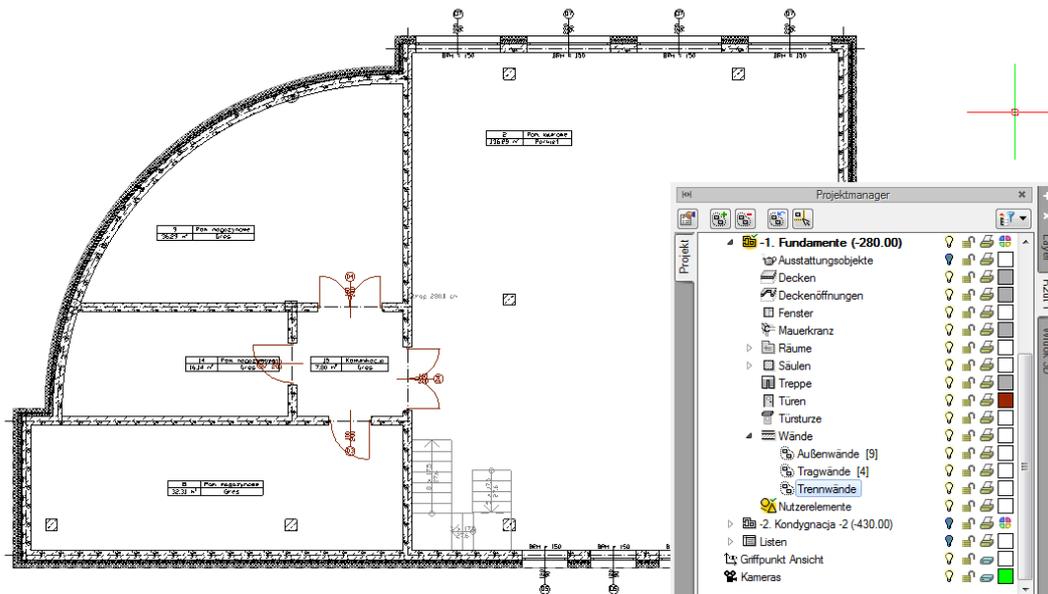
Bearbeitung der Elemente aus einer gewählten Gruppe
